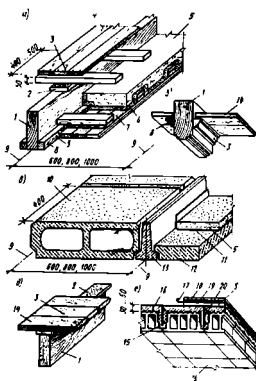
Схемы конструктивных решений перекрытий:
